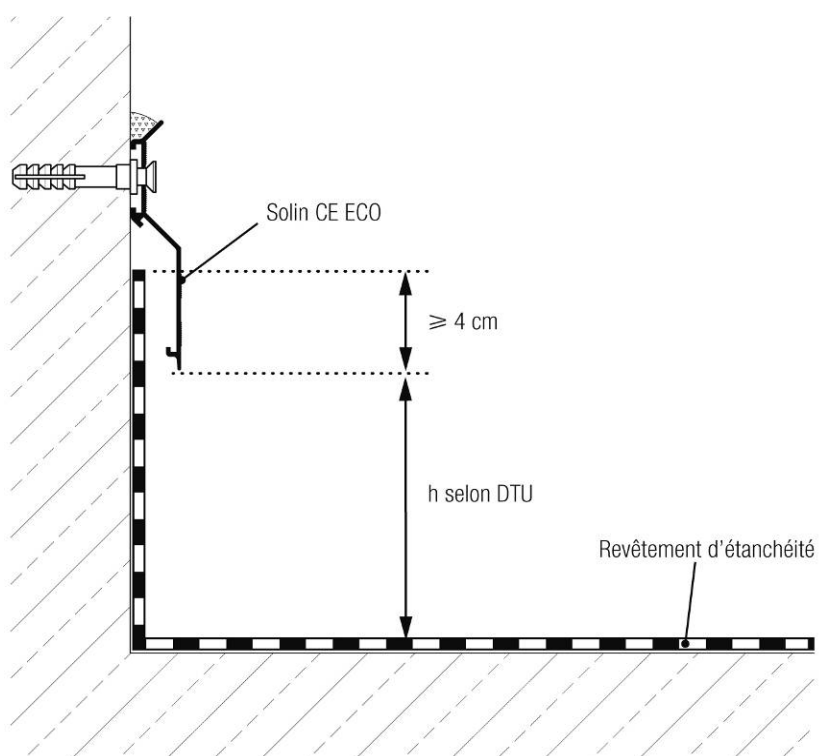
Toiture-terrasse inaccessible, technique ou à zones techniques avec revêtement d'étanchéité autoprotégé
